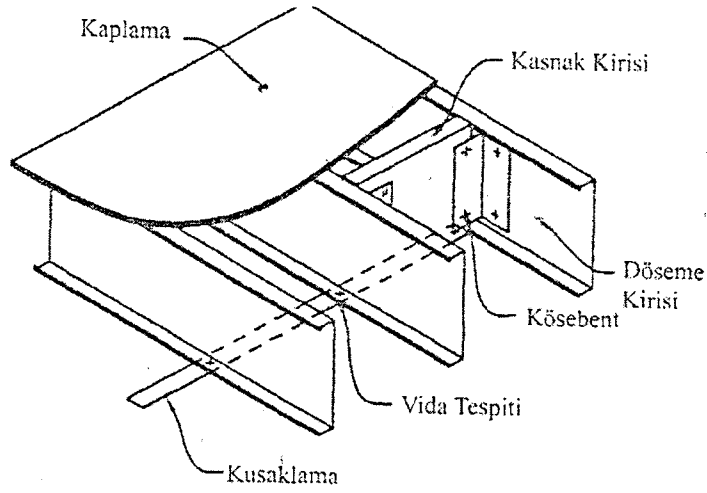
Döşeme kirişinde ek yapılması (NASFA,2000)
